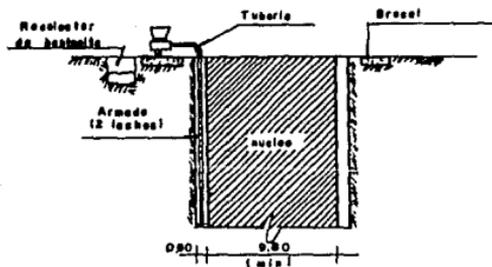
ARMADO Y COLADO DE CADA SECTOR
